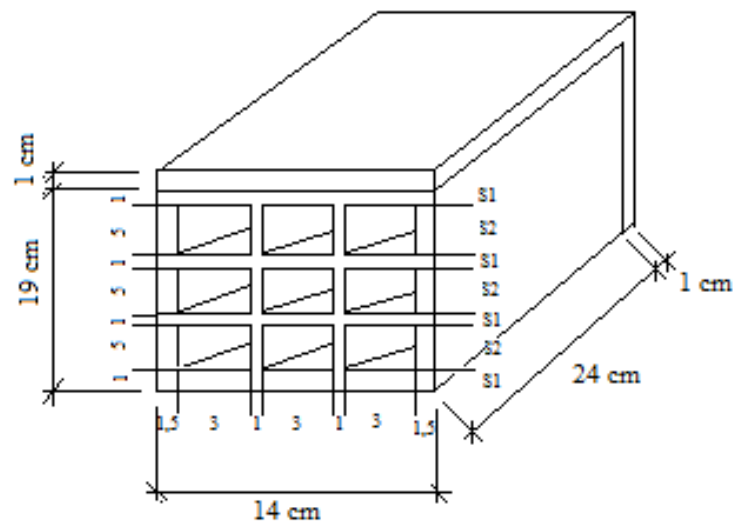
Tijolo parede 1 (Fonte: Arquivo pessoal).
